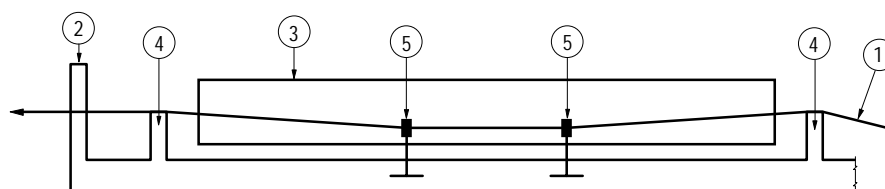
Esquema de execução de vigas com armaduras pré-tracionadas poligonais em leito alongado, permitindo a execução simultânea de várias vigas, em série. (1) armaduras pré-tracionadas; (2) placa de ancoragem; (3) viga de concreto; (4) pontos de apoio das armaduras poligonais; (5) pontos de rebaixamento das armaduras poligonais.
